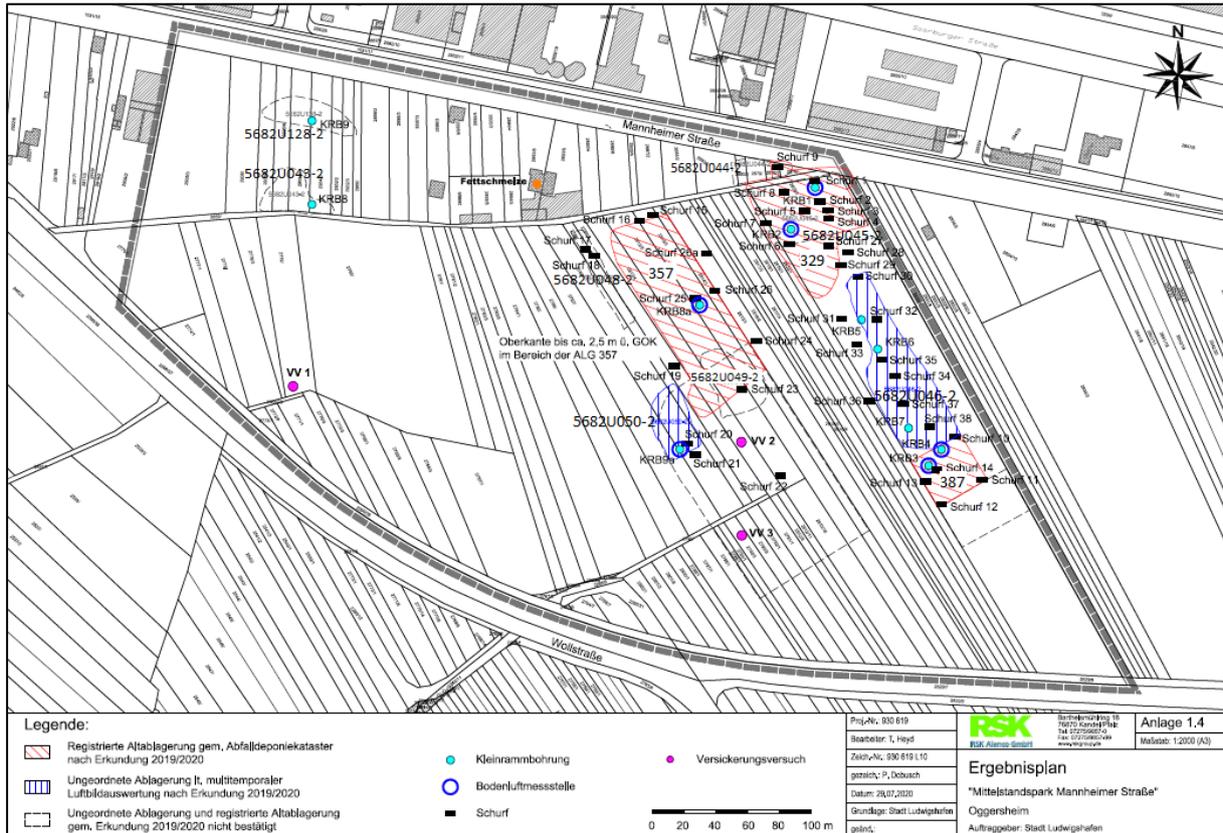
Lageplan der ungeordneten Ablagerungen und Lage der registrierten Altablagungen nach durchgeführter Erkundung.
